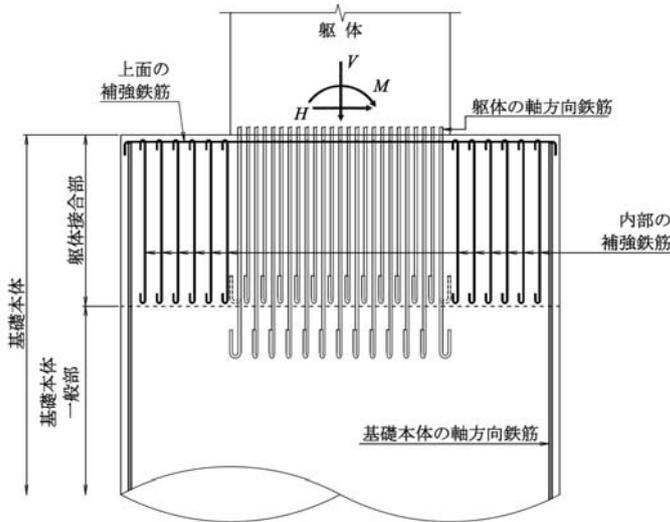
柱状体深礎基礎各部の構造例 (道示IV編, 図-解 15. 7. 1)
